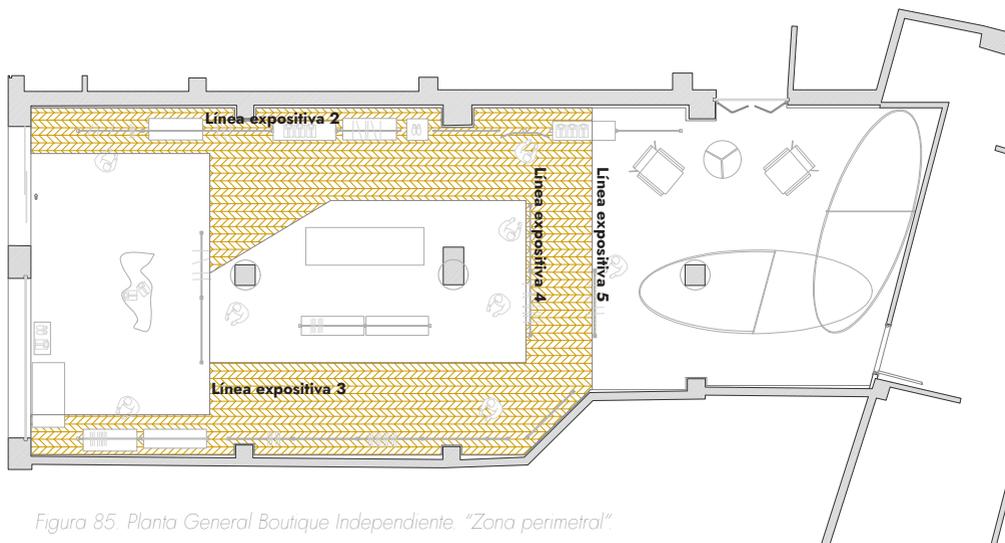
Planta General Boutique Independiente "Zona perimetral"
